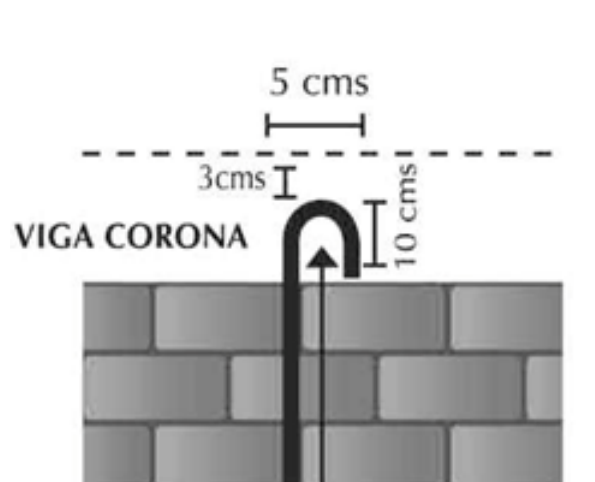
Anclaje del extremo superior de una barra de refuerzo vertical (Bravo, 2007)
